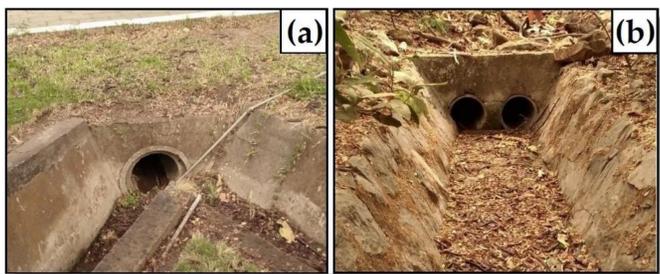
Tubería instalada (Ø500 mm) - Drenaje zona D.
